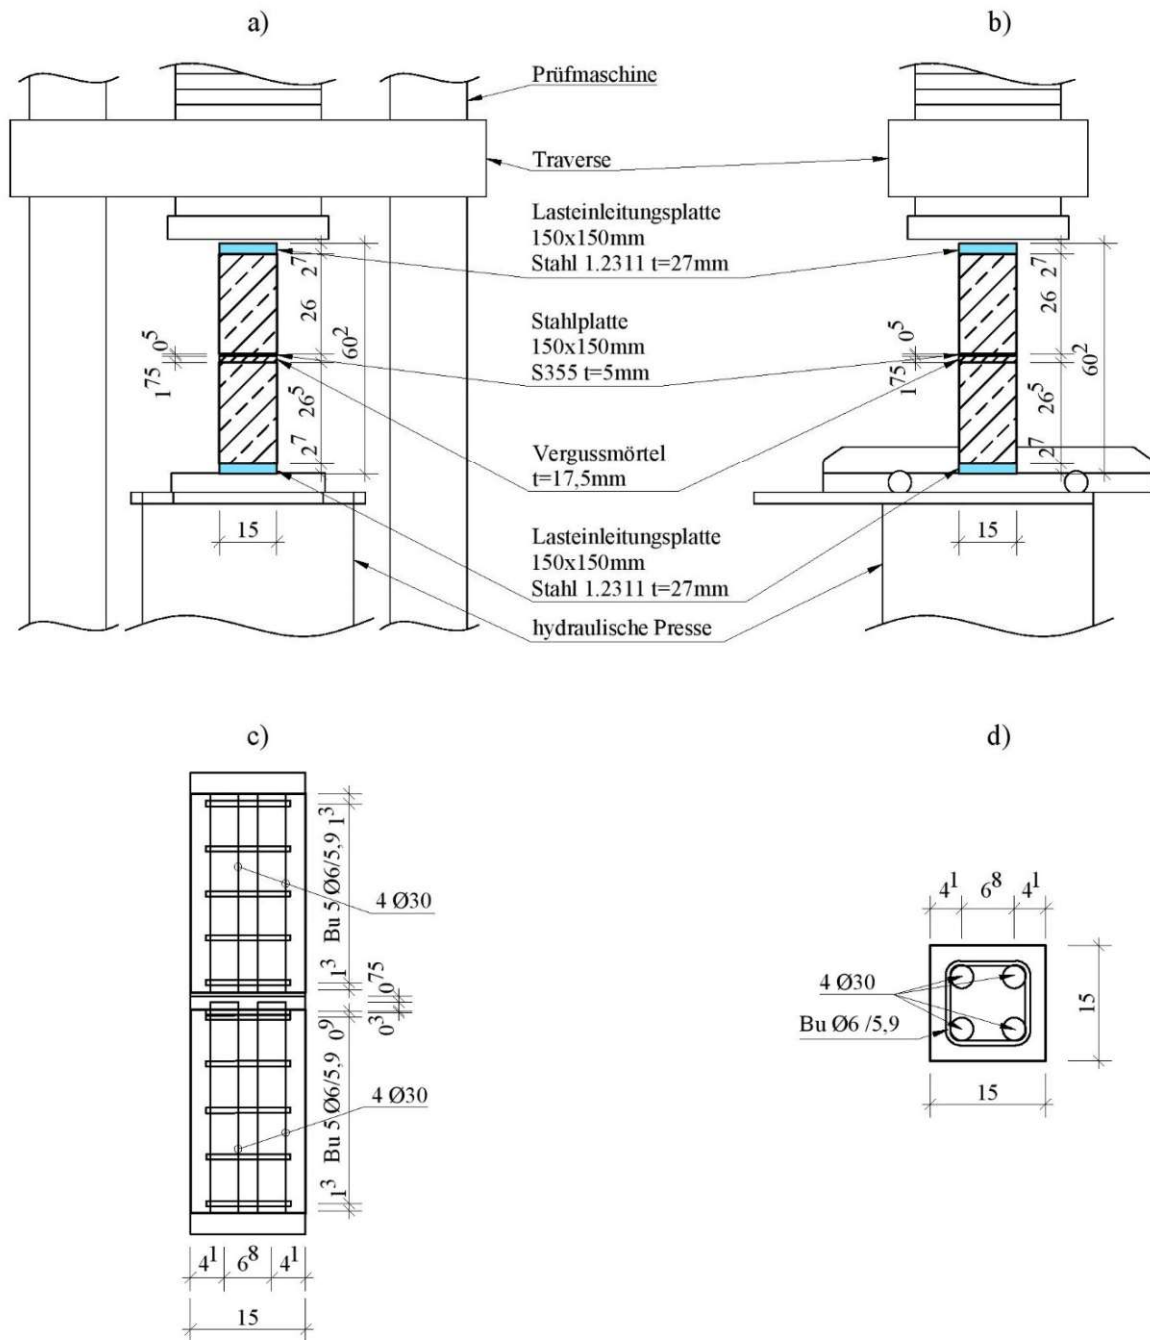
Stütze mit Stumpfstoß und Stirnflächenbewehrung a) Ansicht von vorne, b) Seitenansicht, c) Bewehrung im Aufriss, d) Bewehrung im Grundriss
